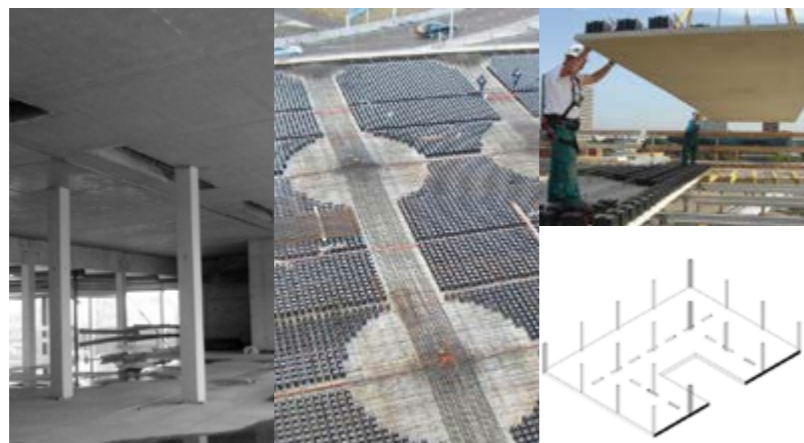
Illustrations de référence planchers-champignons (Source : archipelago architects)
